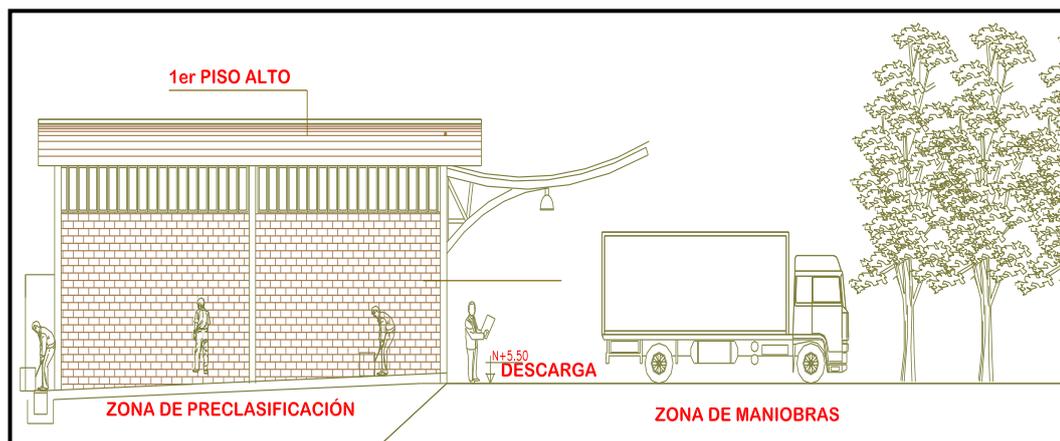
Vista arquitectónica general del primer piso y zona de precalificación
